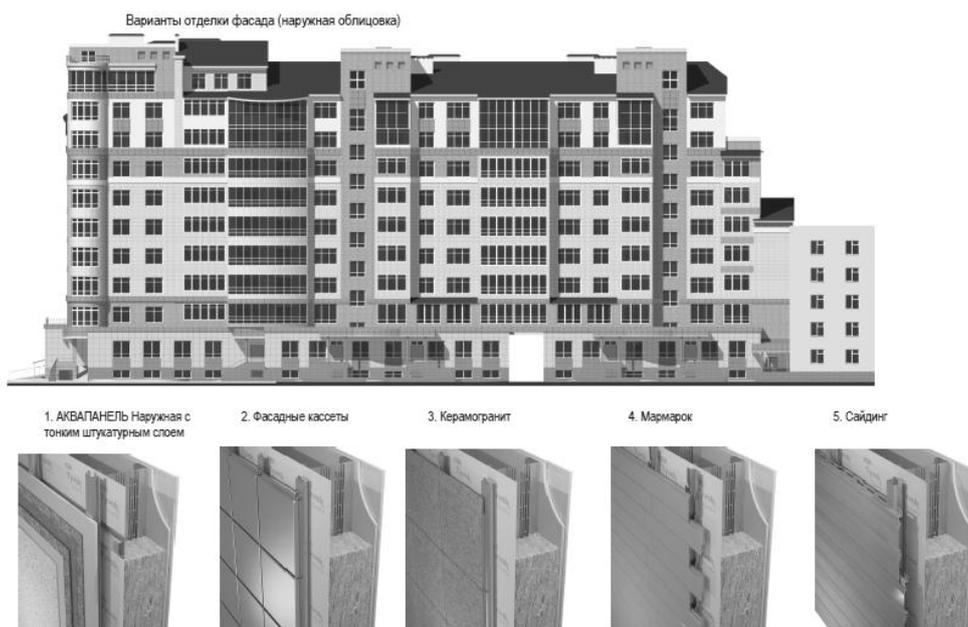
Варианты отделки фасада (наружная облицовка)
